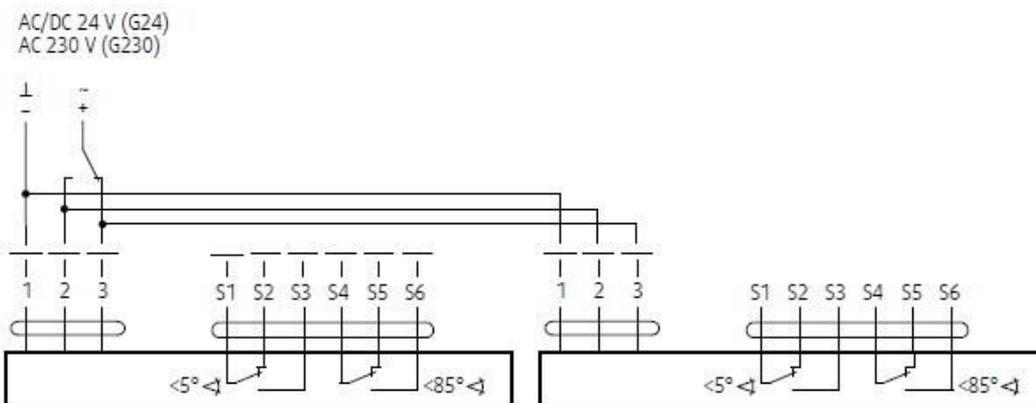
Collegamento in parallelo di due attuatori Gruner su una serranda di movimentazione fumo e calore
